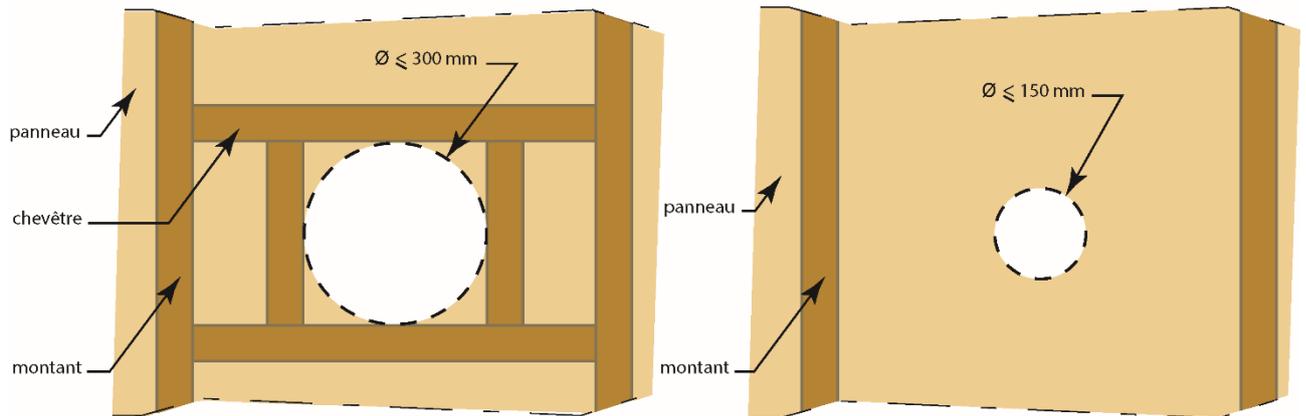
Illustration pour les dimensions maximales des traversées de parois au travers du voile de contreventement.
